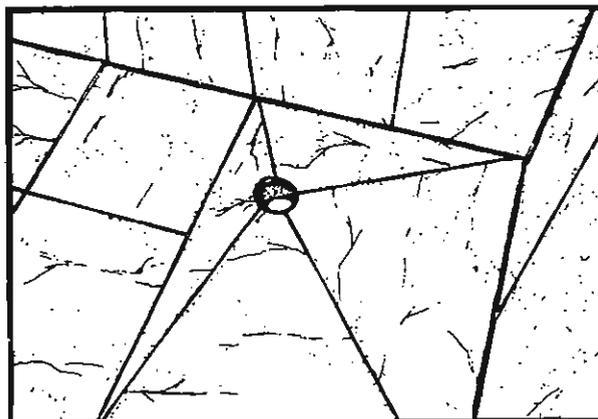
Disposição recomendada para os componentes de pedra em boxes de banheiro.
